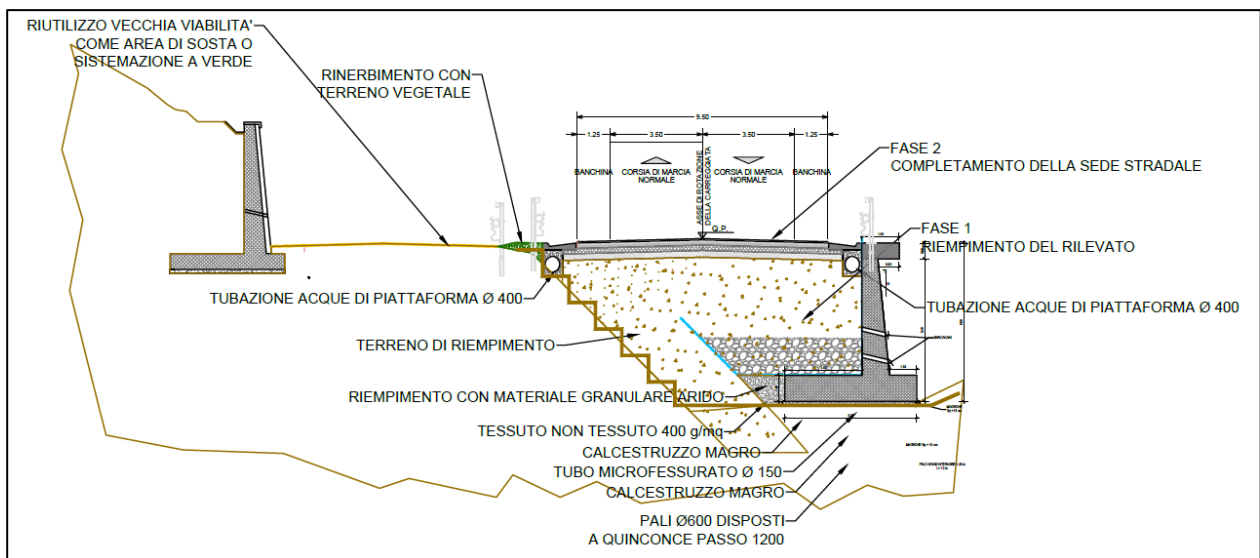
Sezione tipo 1 – Allargamento lato valle con fondazione
